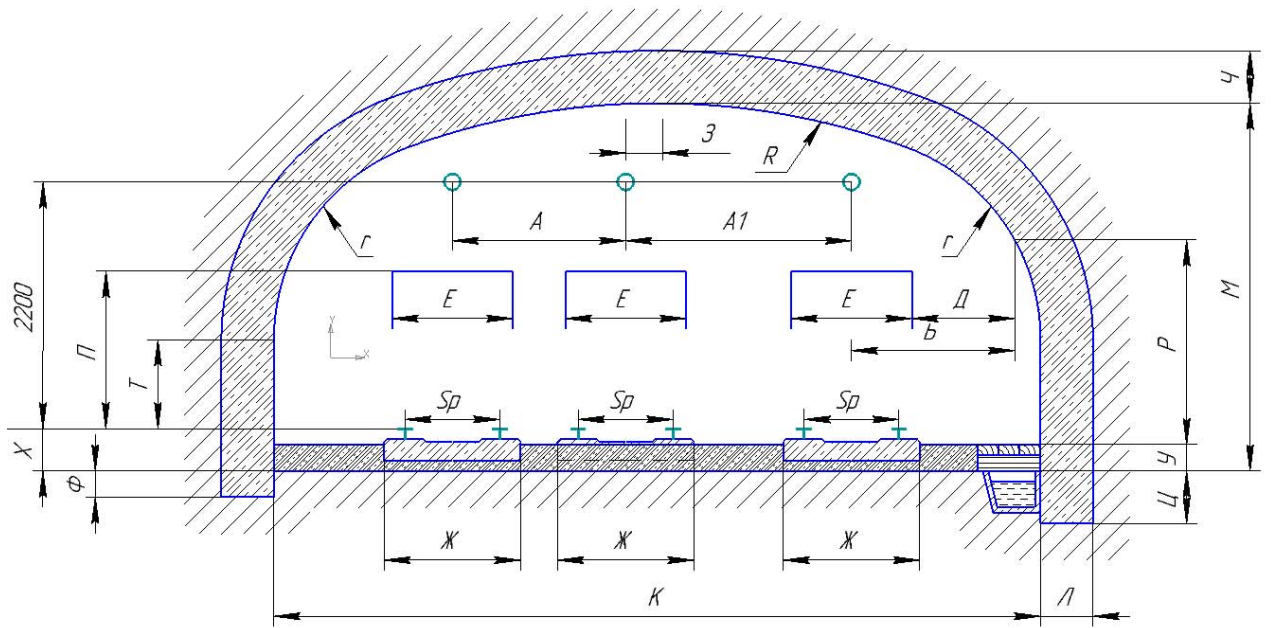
Поперечное сечение трехпутевой горизонтальной выработки с бетонной монолитной крепью
